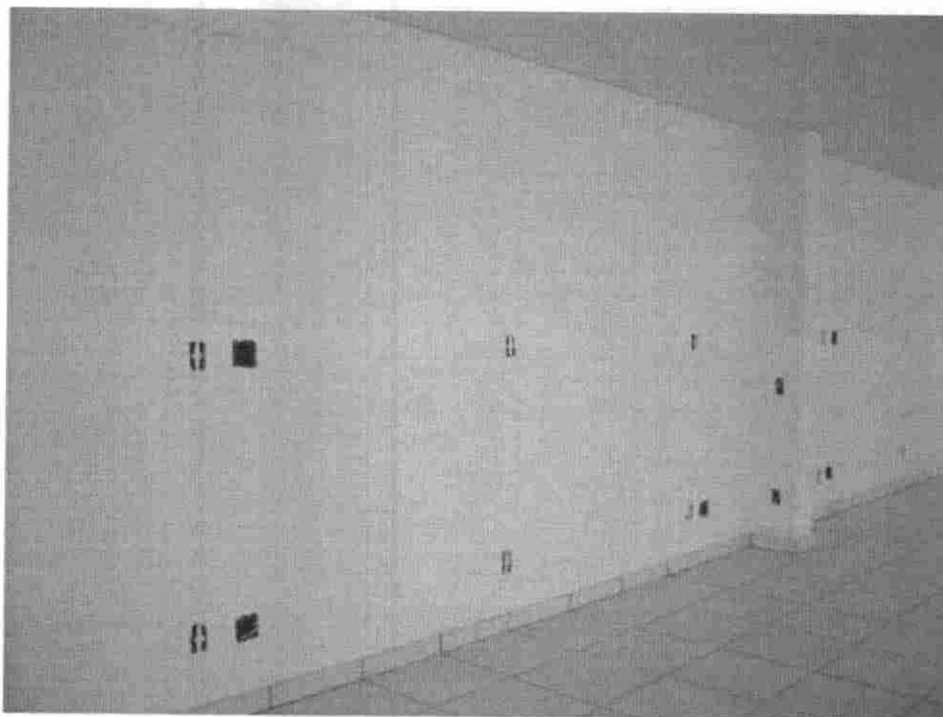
1º pavimento. Destaque para as instalações elétricas parcialmente executadas.
